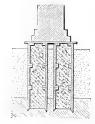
Eiserne, mit Beton gefüllte Senkröhren.
